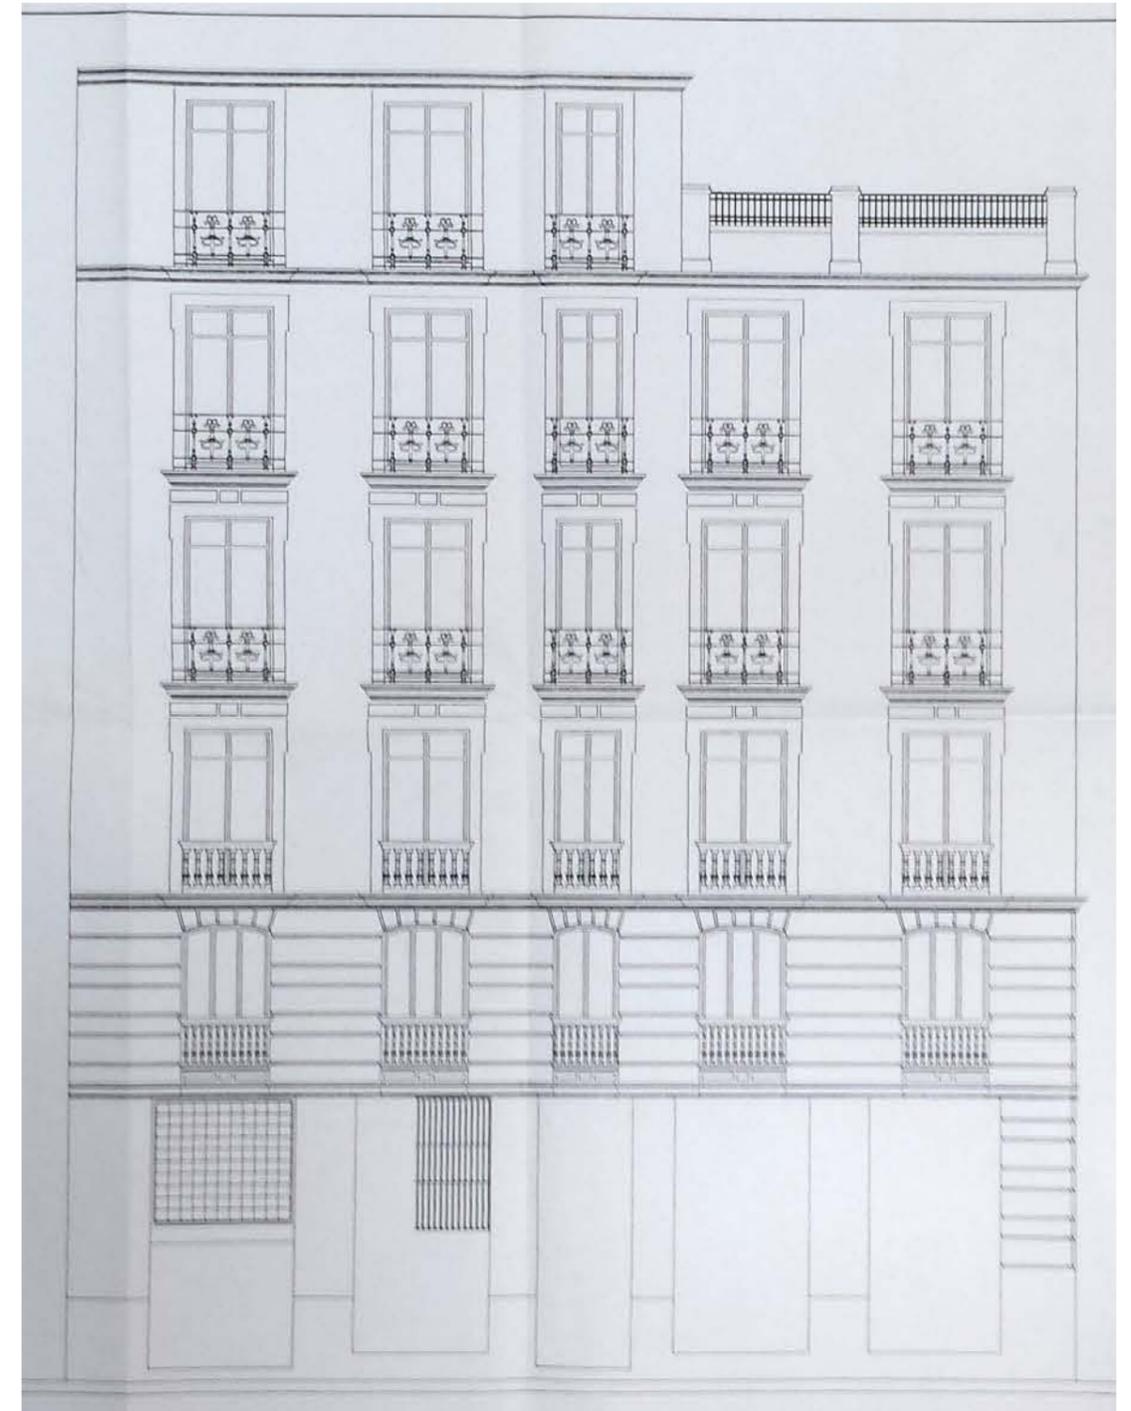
Estado Actual Alzado Calle Cardenal Paya 1997.
